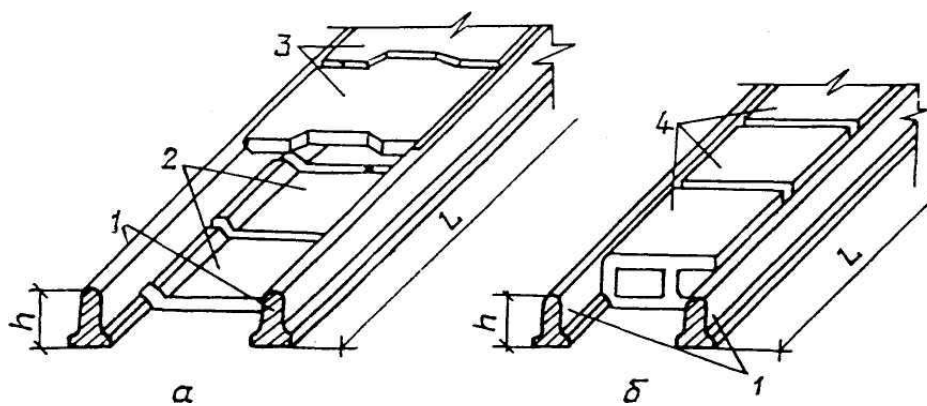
Малорозмірні збірні залізобетонні конструкції перекриттів:
